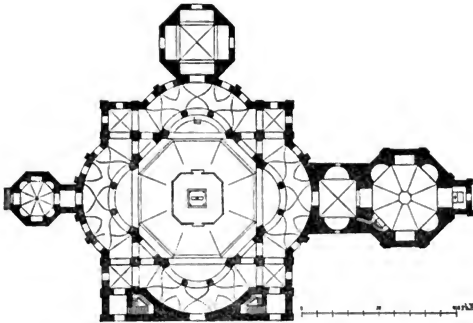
Grundriss von S. Lorenzo in Mailand (nach Rahn).
